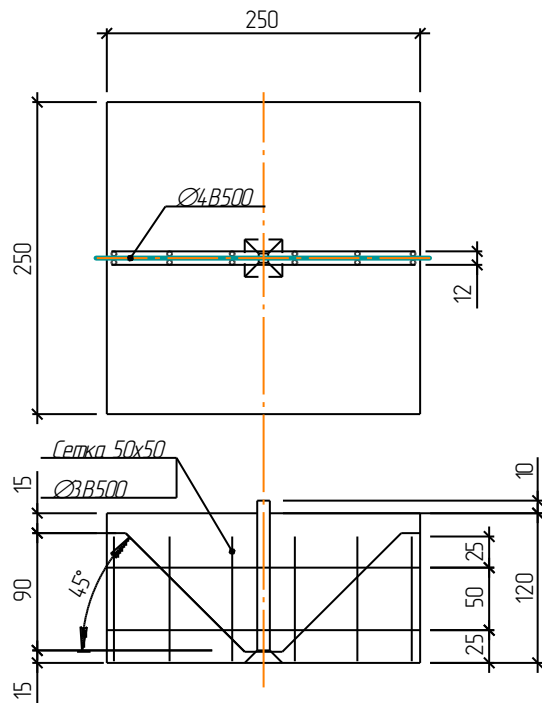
Опытный образец заармированный вертикальными каркасами совместно с отгибами диаметром 4 мм.
